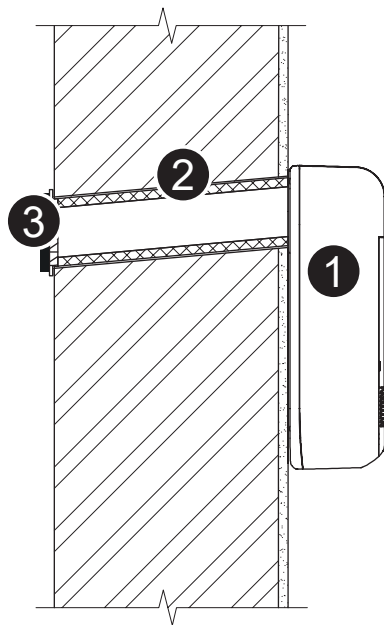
Крепление на стены из легких минеральных материалов (газобетон, шлакобетон, пенобетон)
